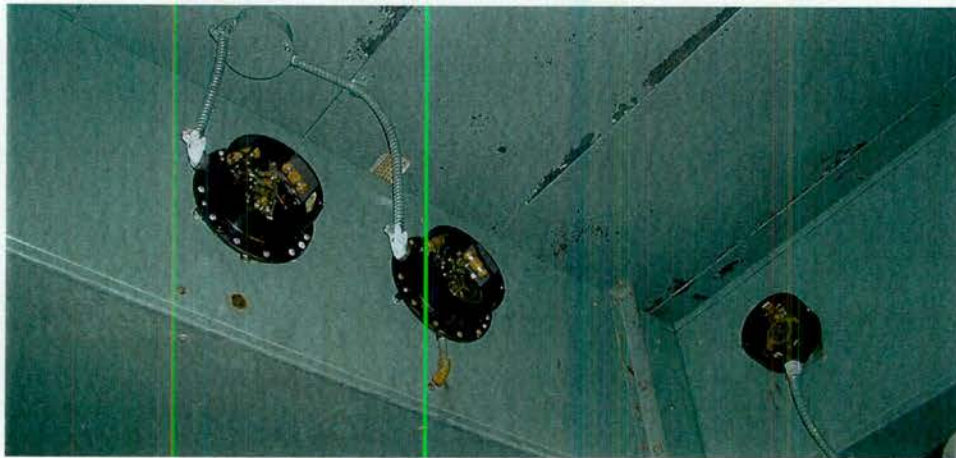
Boîtes métalliques noires contenant des interrupteurs au mercure situées sur les conduits de chauffage de la salle des génératrices (site 330, le 6 septembre 2000).
